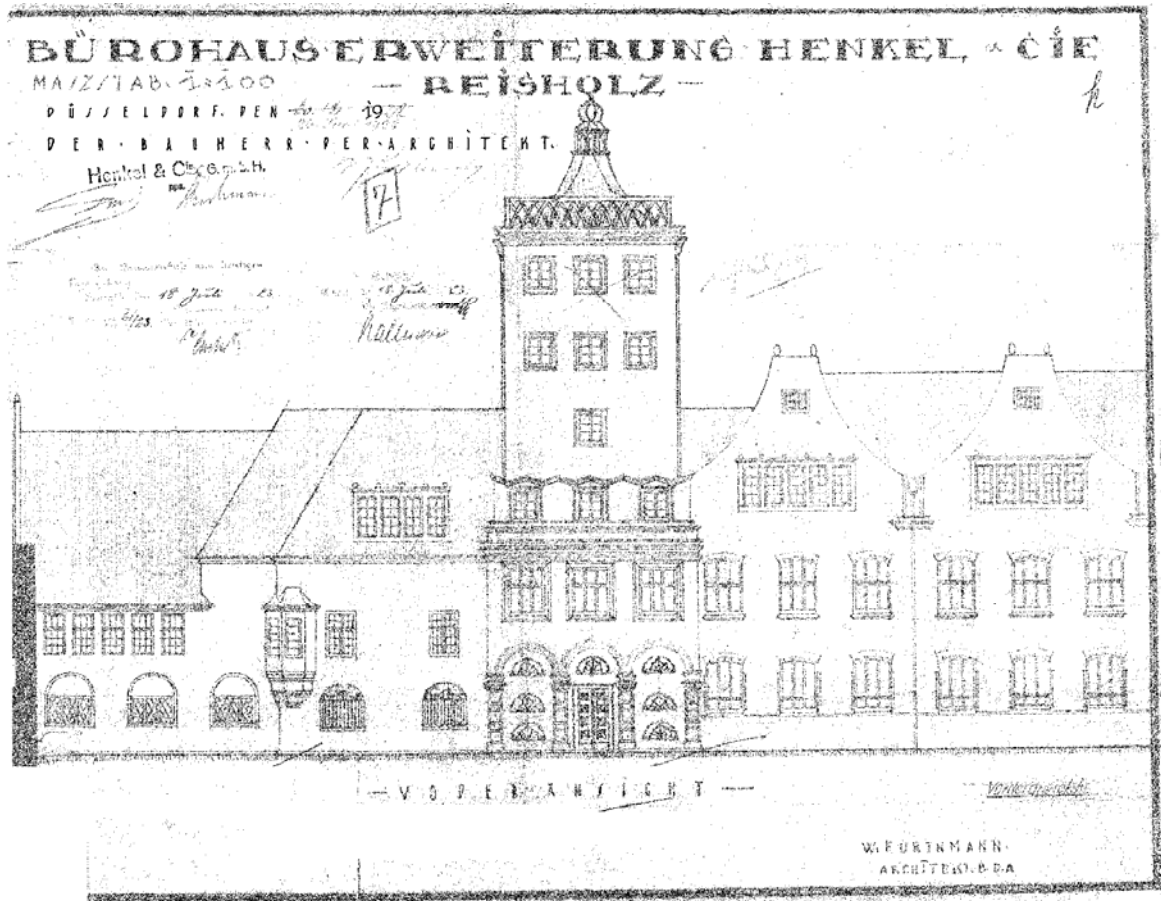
Verwaltungsbau – Überbauung der Werksgasse mit einem Turmbau, Entwurf mit Erstdatierung von 1922/ Zweitdatierung 1923/ 1927 (übergeschrieben, schwach lesbar) – Architekt: Walter Furthmann
